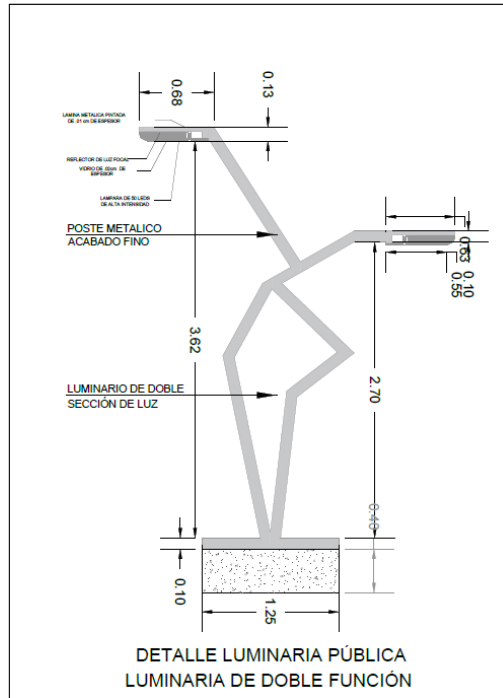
, *Detalle técnico constructivo de la luminaria pública.
